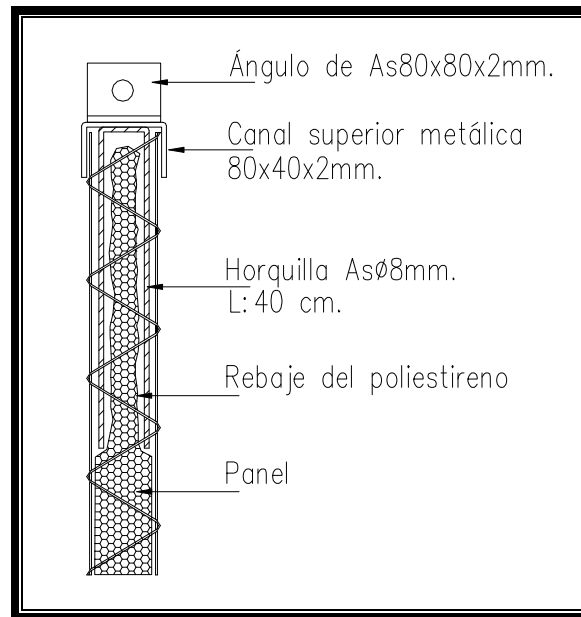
Detalle de fijación de accesorio para unir la techumbre (vista lateral)
